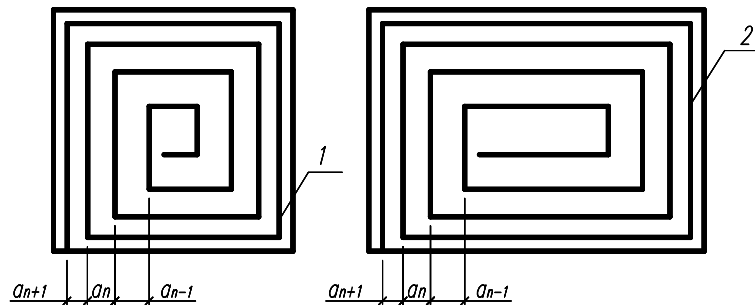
Принципиальная схема конструирования усовершенствованных спиральных сеток для армирования элементов квадратного (1) и прямоугольного (2) поперечных сечений
